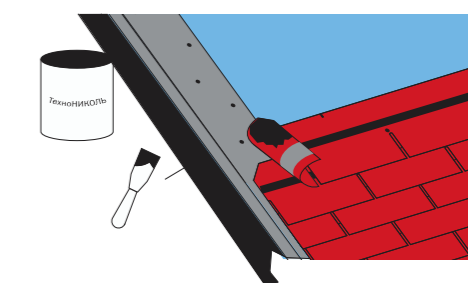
Укладка SHINGLAS на фронтовом свесе
